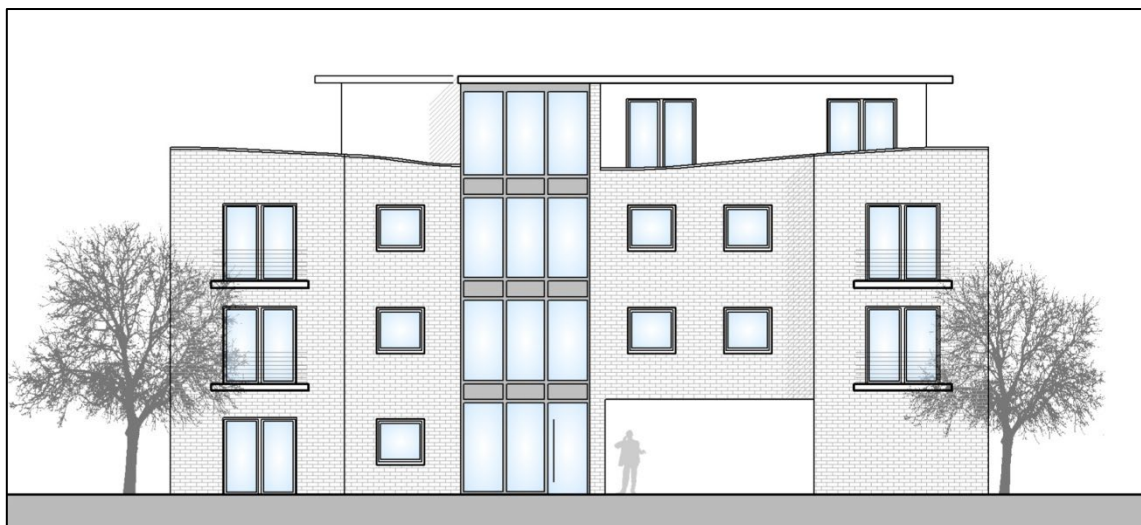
Ansicht des Baukörpers an der Kirchstraße von Westen (Architekt Friedmann)
